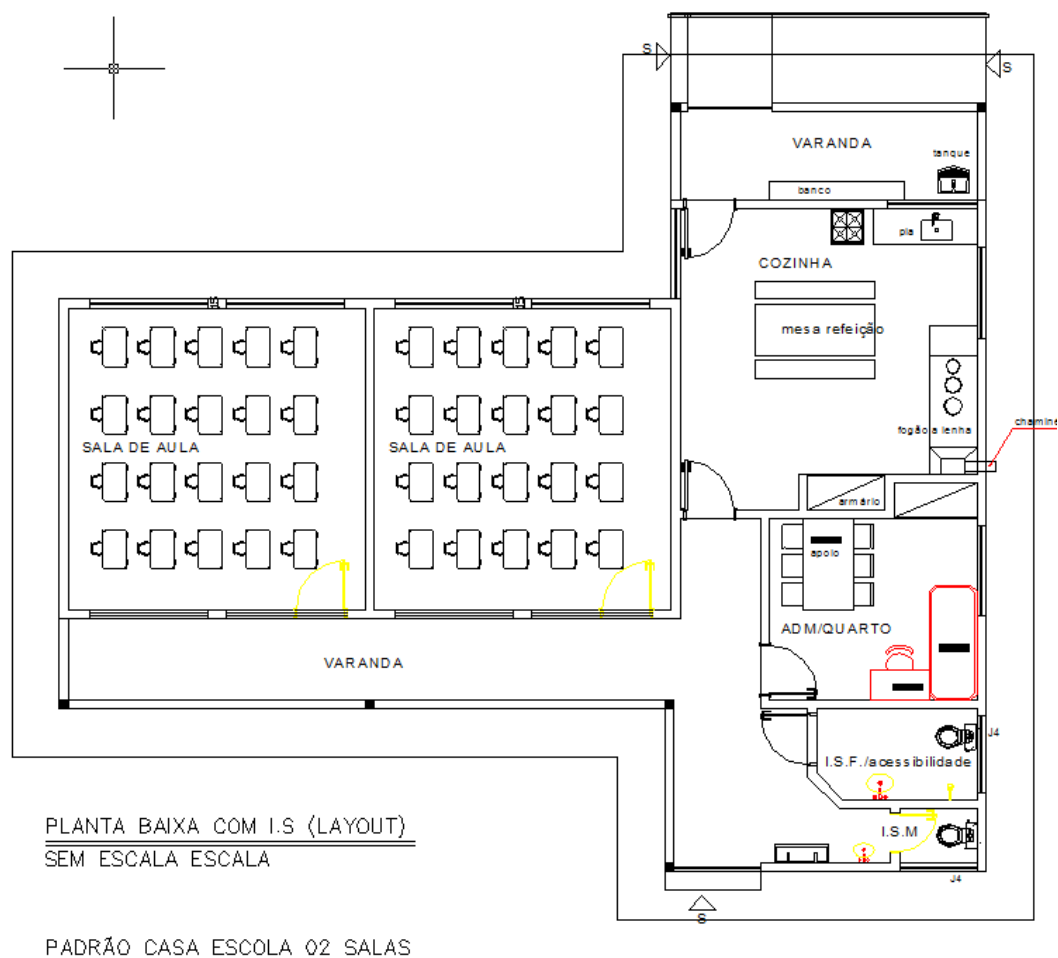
Planta do Projeto “Casa Escola” com 02 salas.
